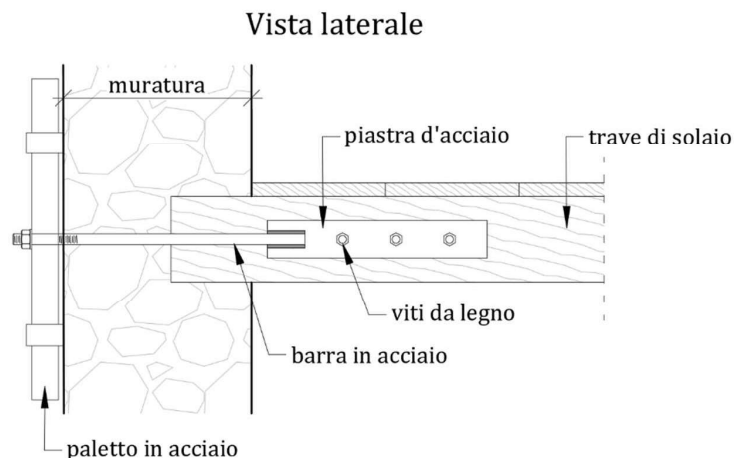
Esempio di connettore a paletto in acciaio, tra le travi di solaio e la muratura
